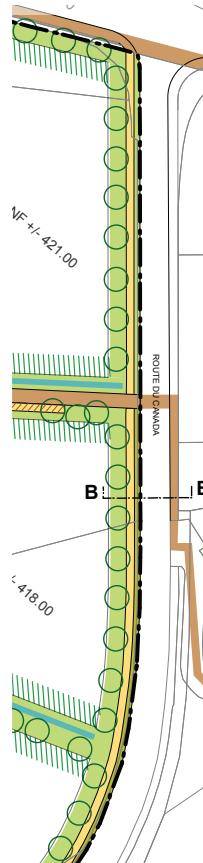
Exemple d'aménagement d'un trottoir séparé de la route par de la végétation, la Pallanterie
